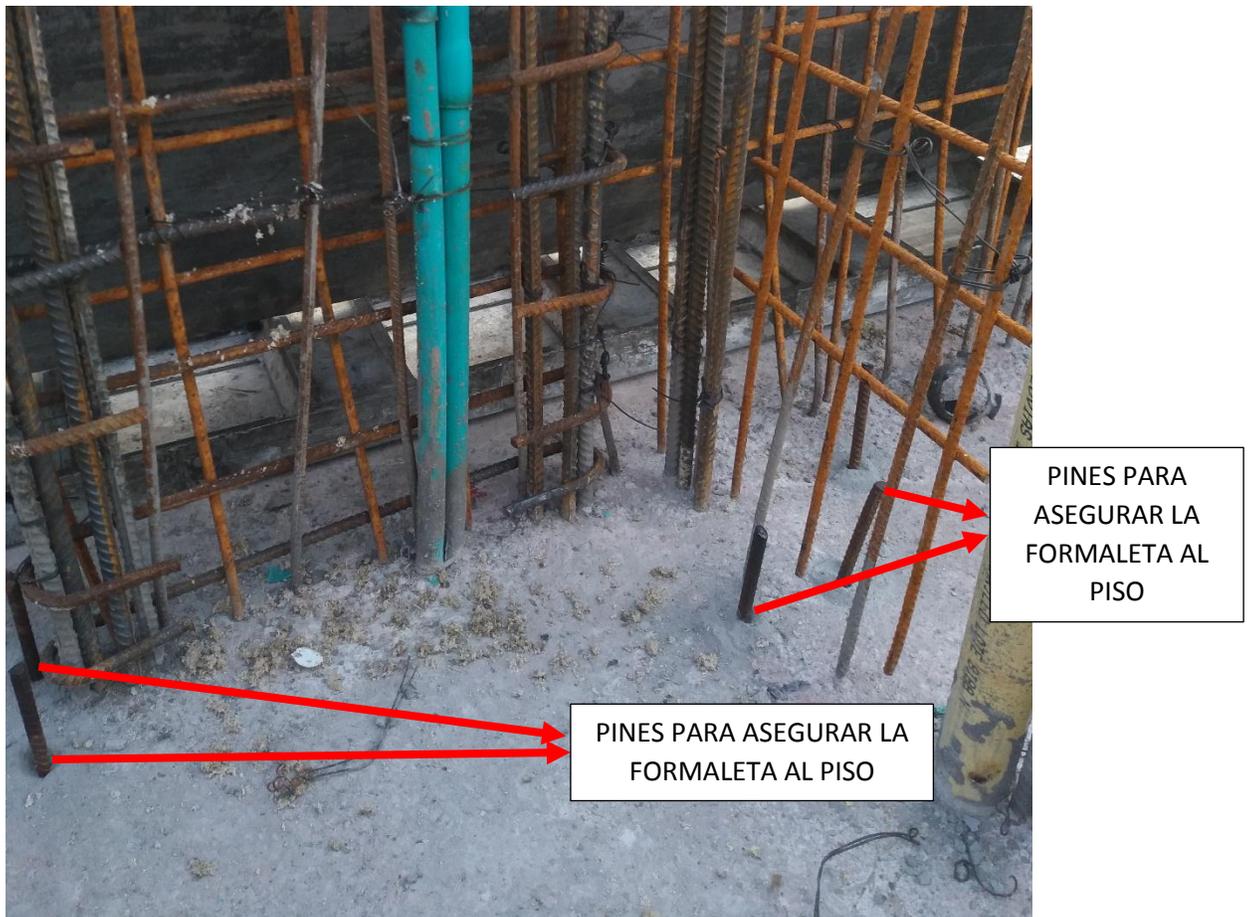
elementos de anclaje a la losa de la formaleta. Fuente: Propia
